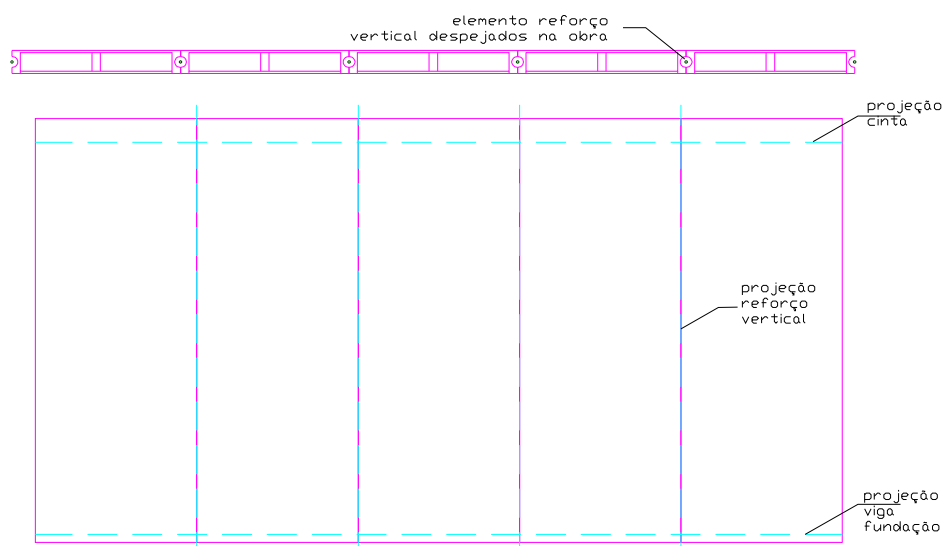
Conexão dos painéis referente à primeira alternativa de sistema construtivo.
